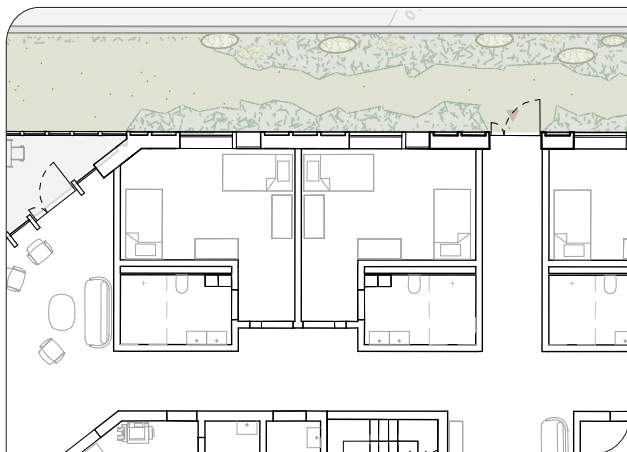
Zweibettzimmer für Personen mit Demenz (Erdgeschoss)
